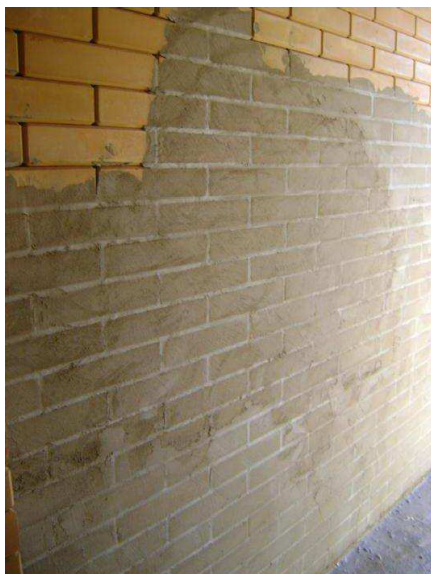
Reboco em alvenaria de tijolo de solo-cimento.
